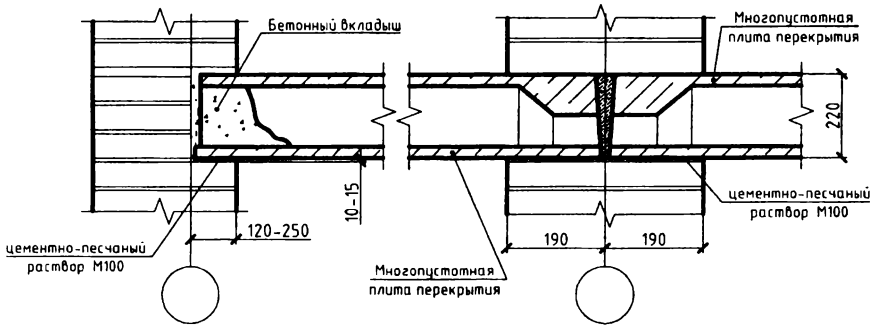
Схема опирания многопустотной плиты на наружную и внутреннюю стены
